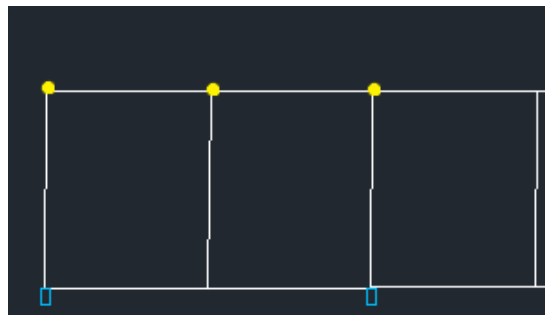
Figura XIII. Plano iluminación plazas aisladas segunda fila (realizado en AutoCAD).
